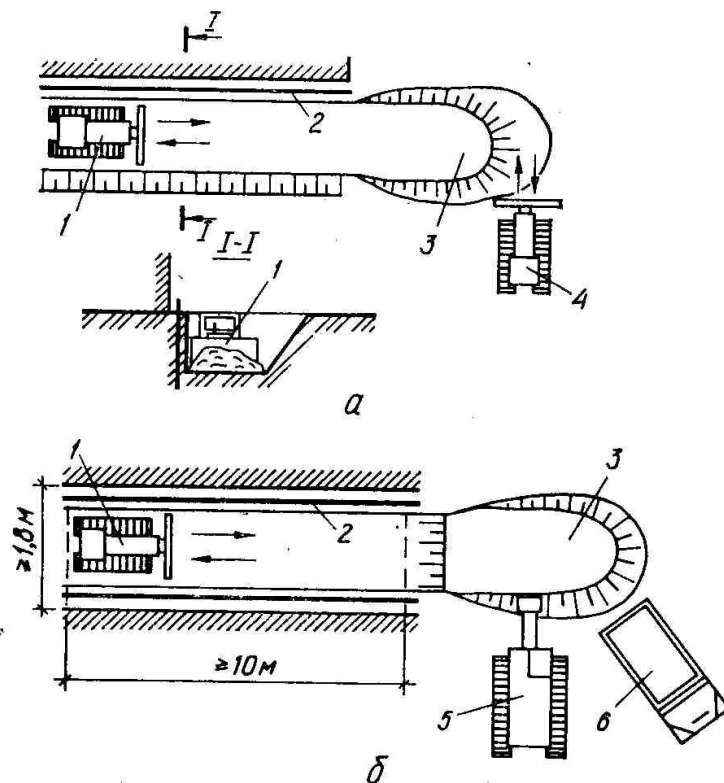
Разработка грунта бульдозером в стесненных условиях:
